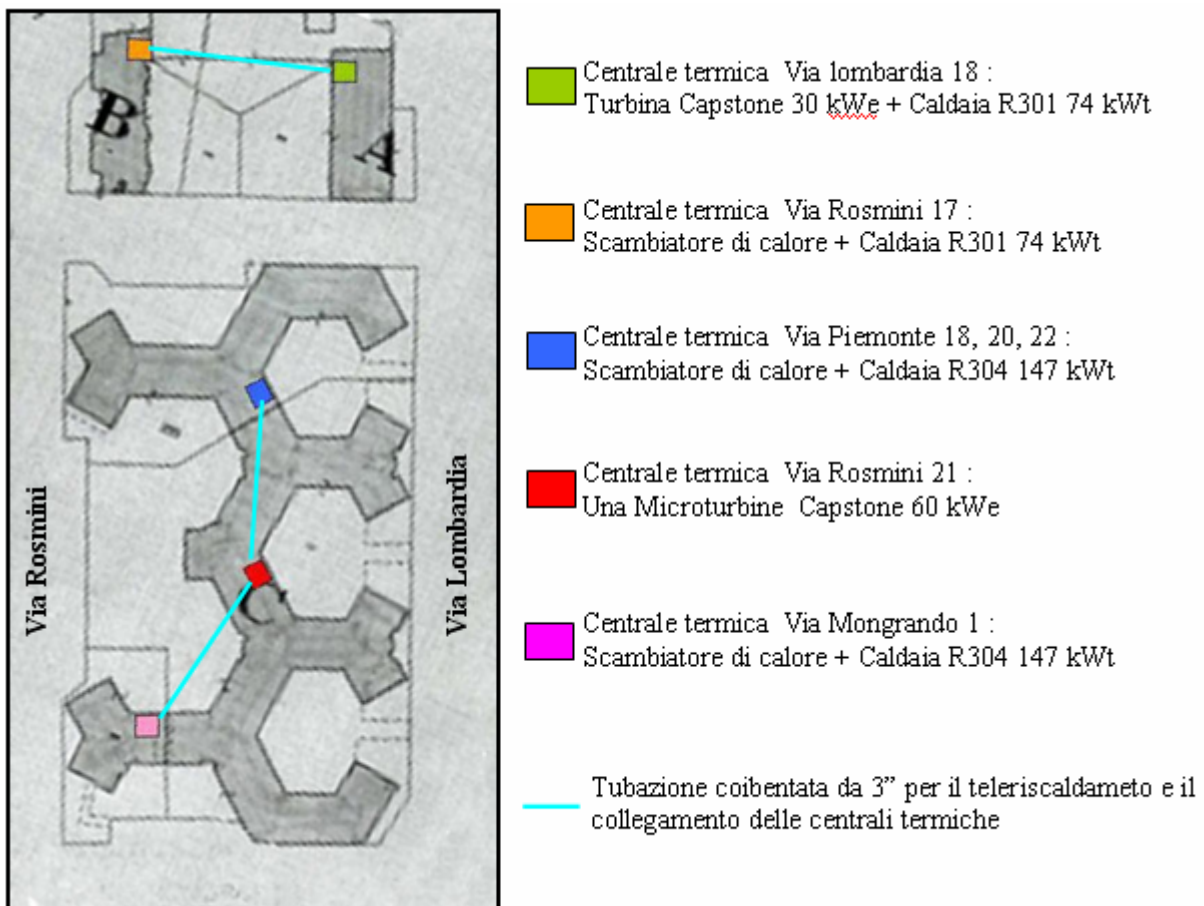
Layout rete di tele riscaldamento abbinata a intervento tipo 2
